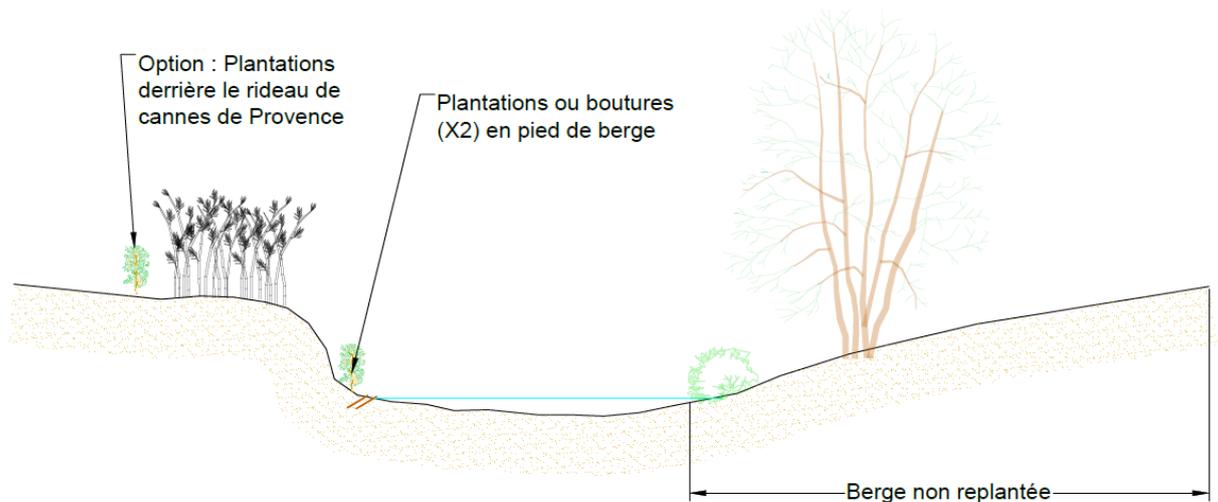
Coupe de principe de plantation type 1 : pied de berge
